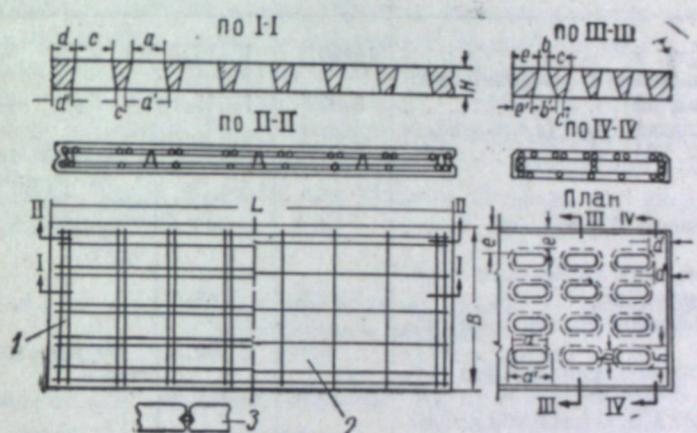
Инвентарные железобетонные решетчатые плиты для покрытия карьерных автомобильных дорог:
